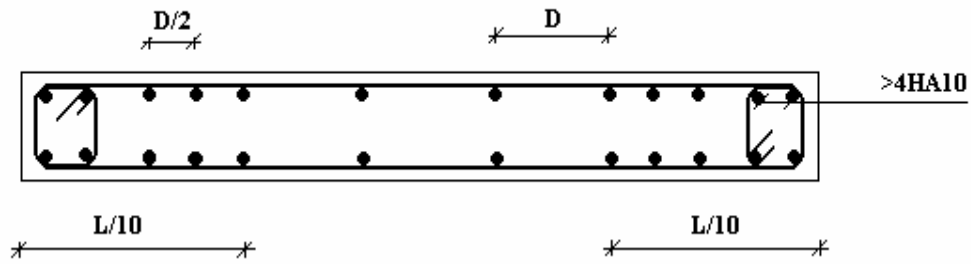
Disposition des armatures verticales dans les voiles.
